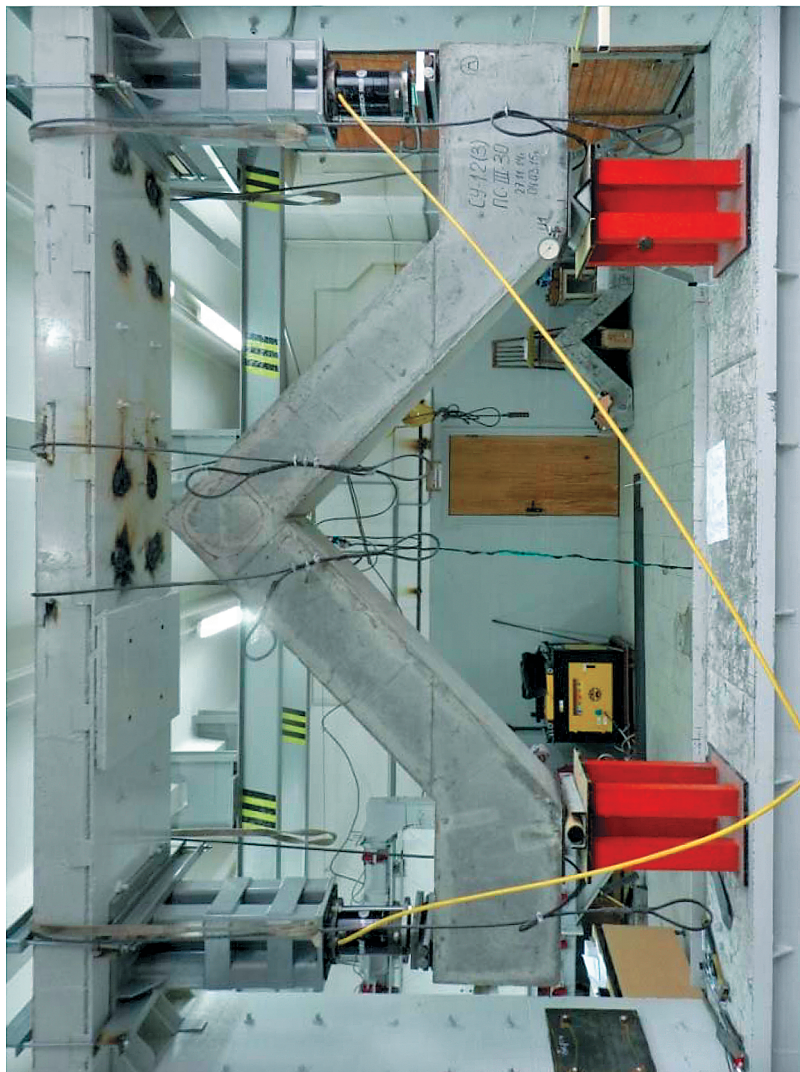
Железобетонная модель углового типа СУ-1.2 (3) в испытательном стенде
